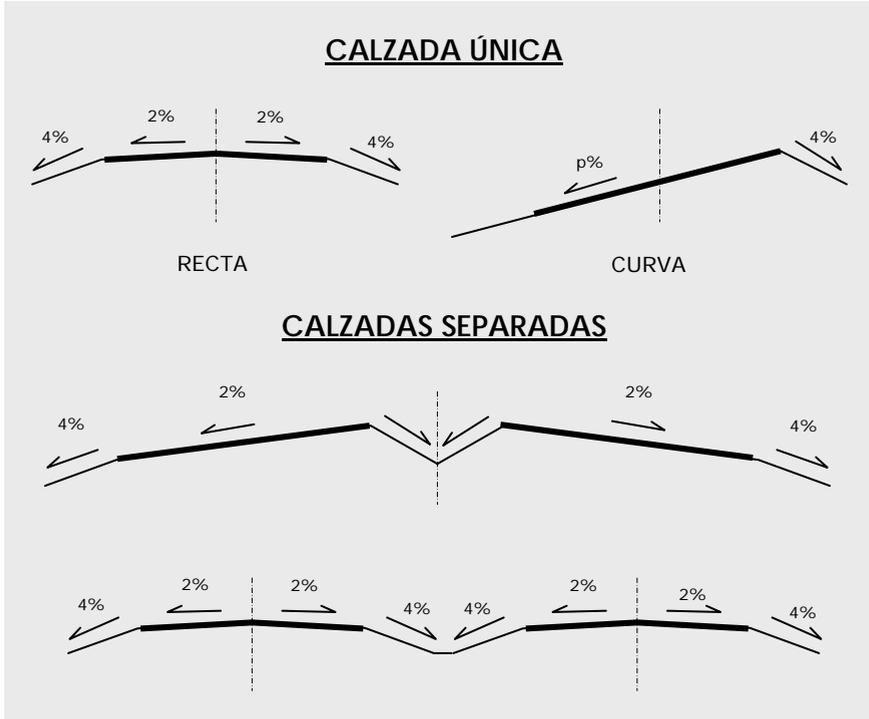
Secciones contempladas por la Instrucción de carreteras
